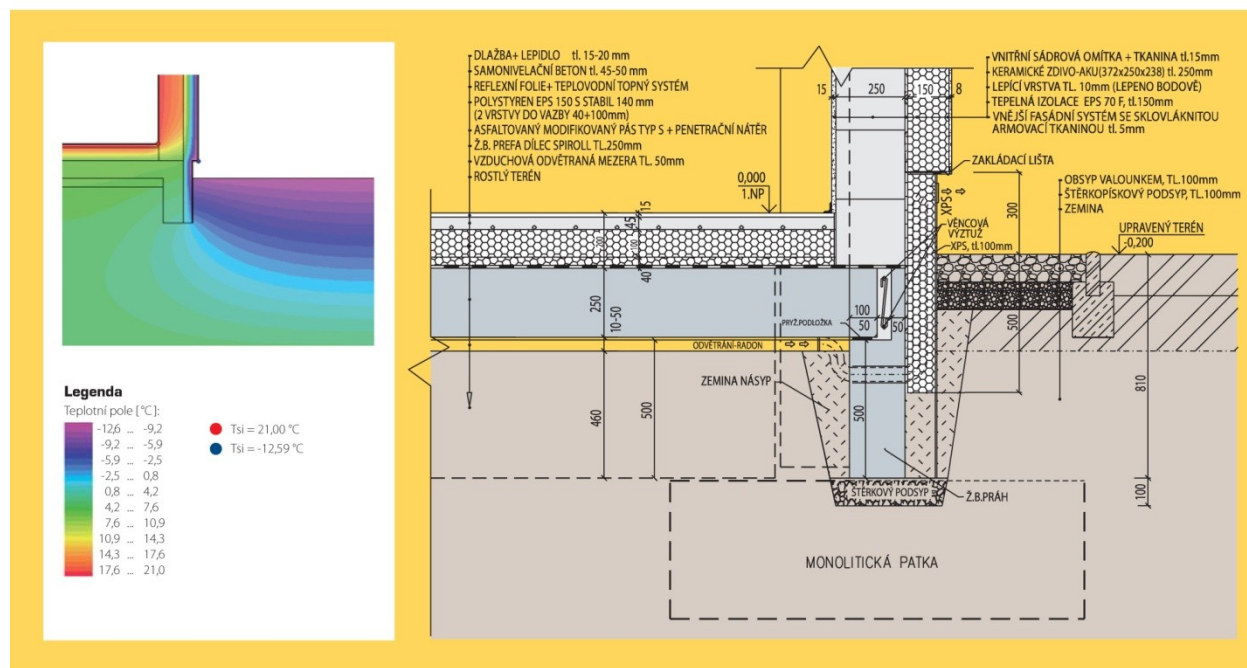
Popis konstrukce (Zdroj: <http://www.skeletsystem.cz/technicke-detaily-a-konstrukcni-zasady/>)
